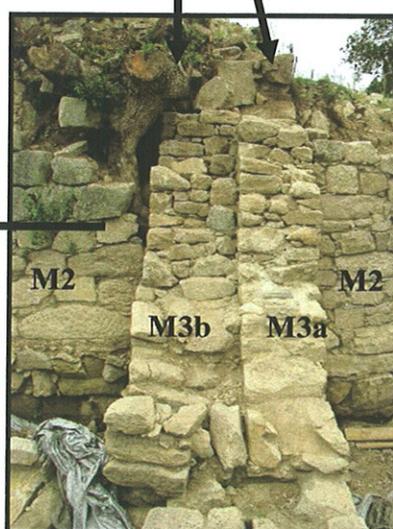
Vista desde Suroeste hacia Noroeste y nomenclaturas en fichas de conservación. M3a es el primero en ejecutarse.
